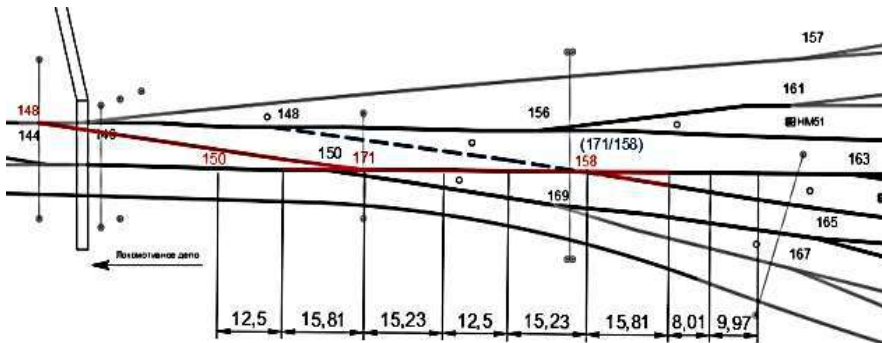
Схема укладки СП № 171 и СП № 158 взамен перекрестного стрелочного перевода
